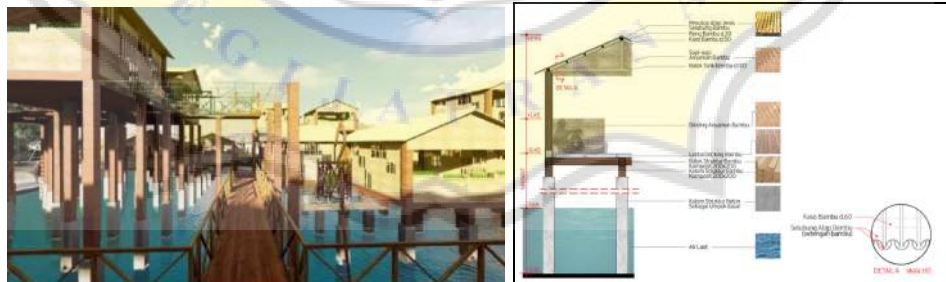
Water Villa dengan teknologi Floating Hollow Concrete Box
